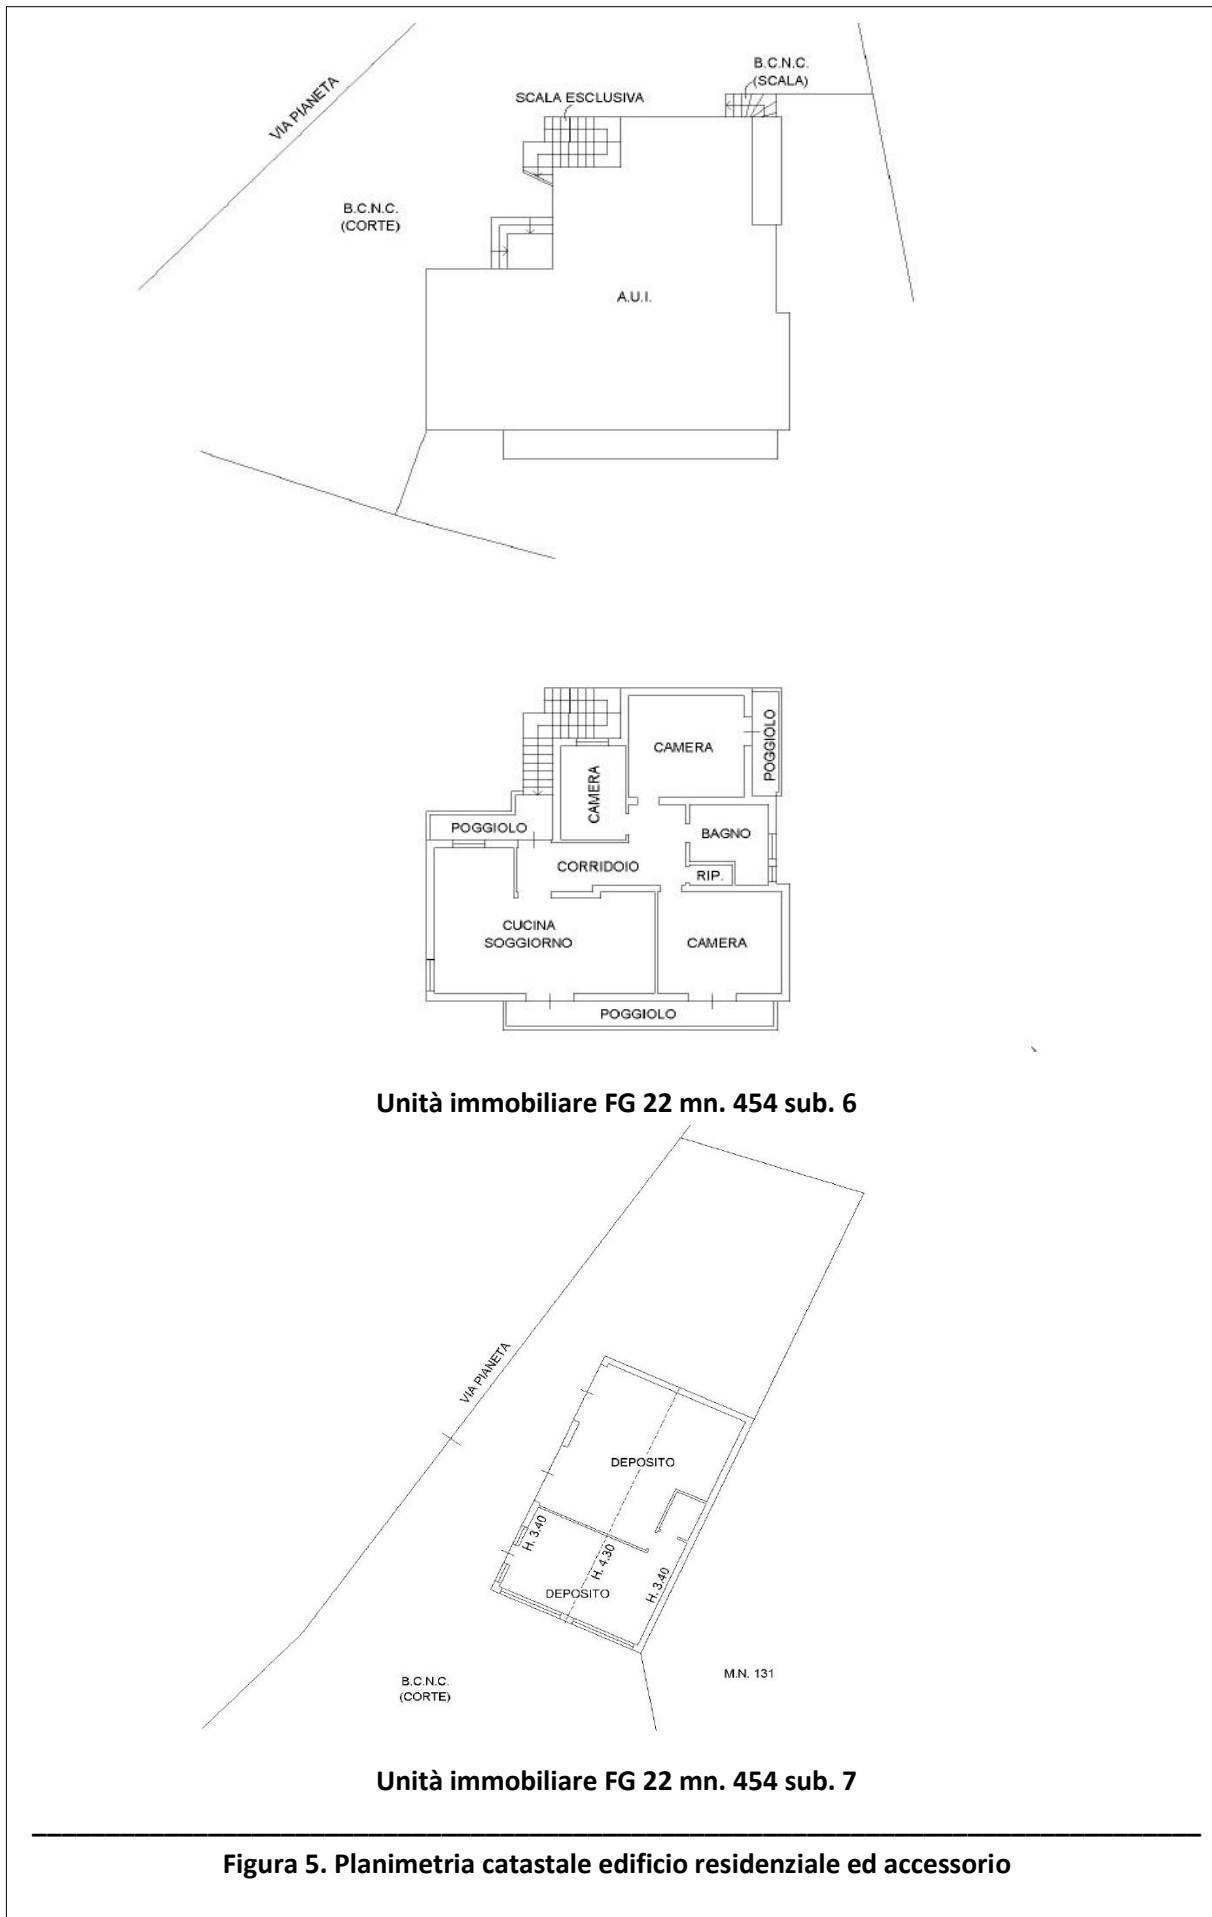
Planimetria catastale edificio residenziale ed accessorio
